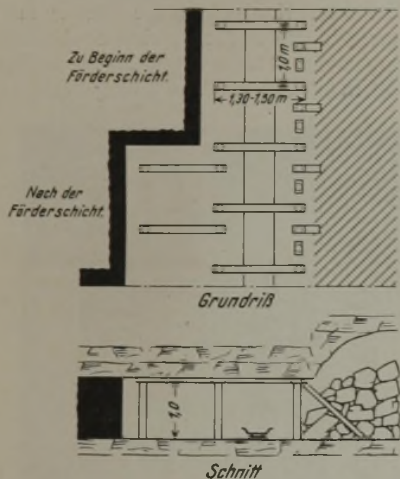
Strebruchbau ohne Wanderpfeiler auf Holzstempeln.
